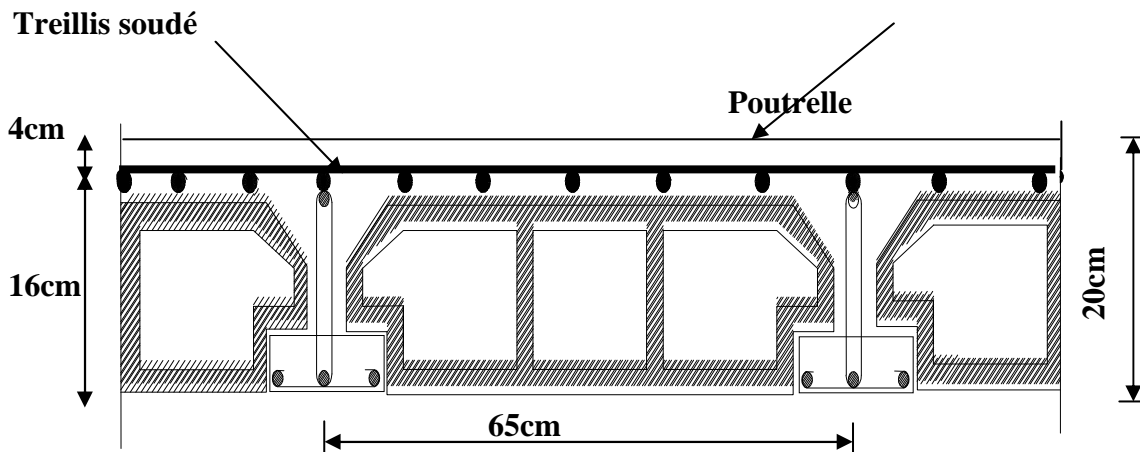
Coupe transversale d'un plancher en corps creux.
